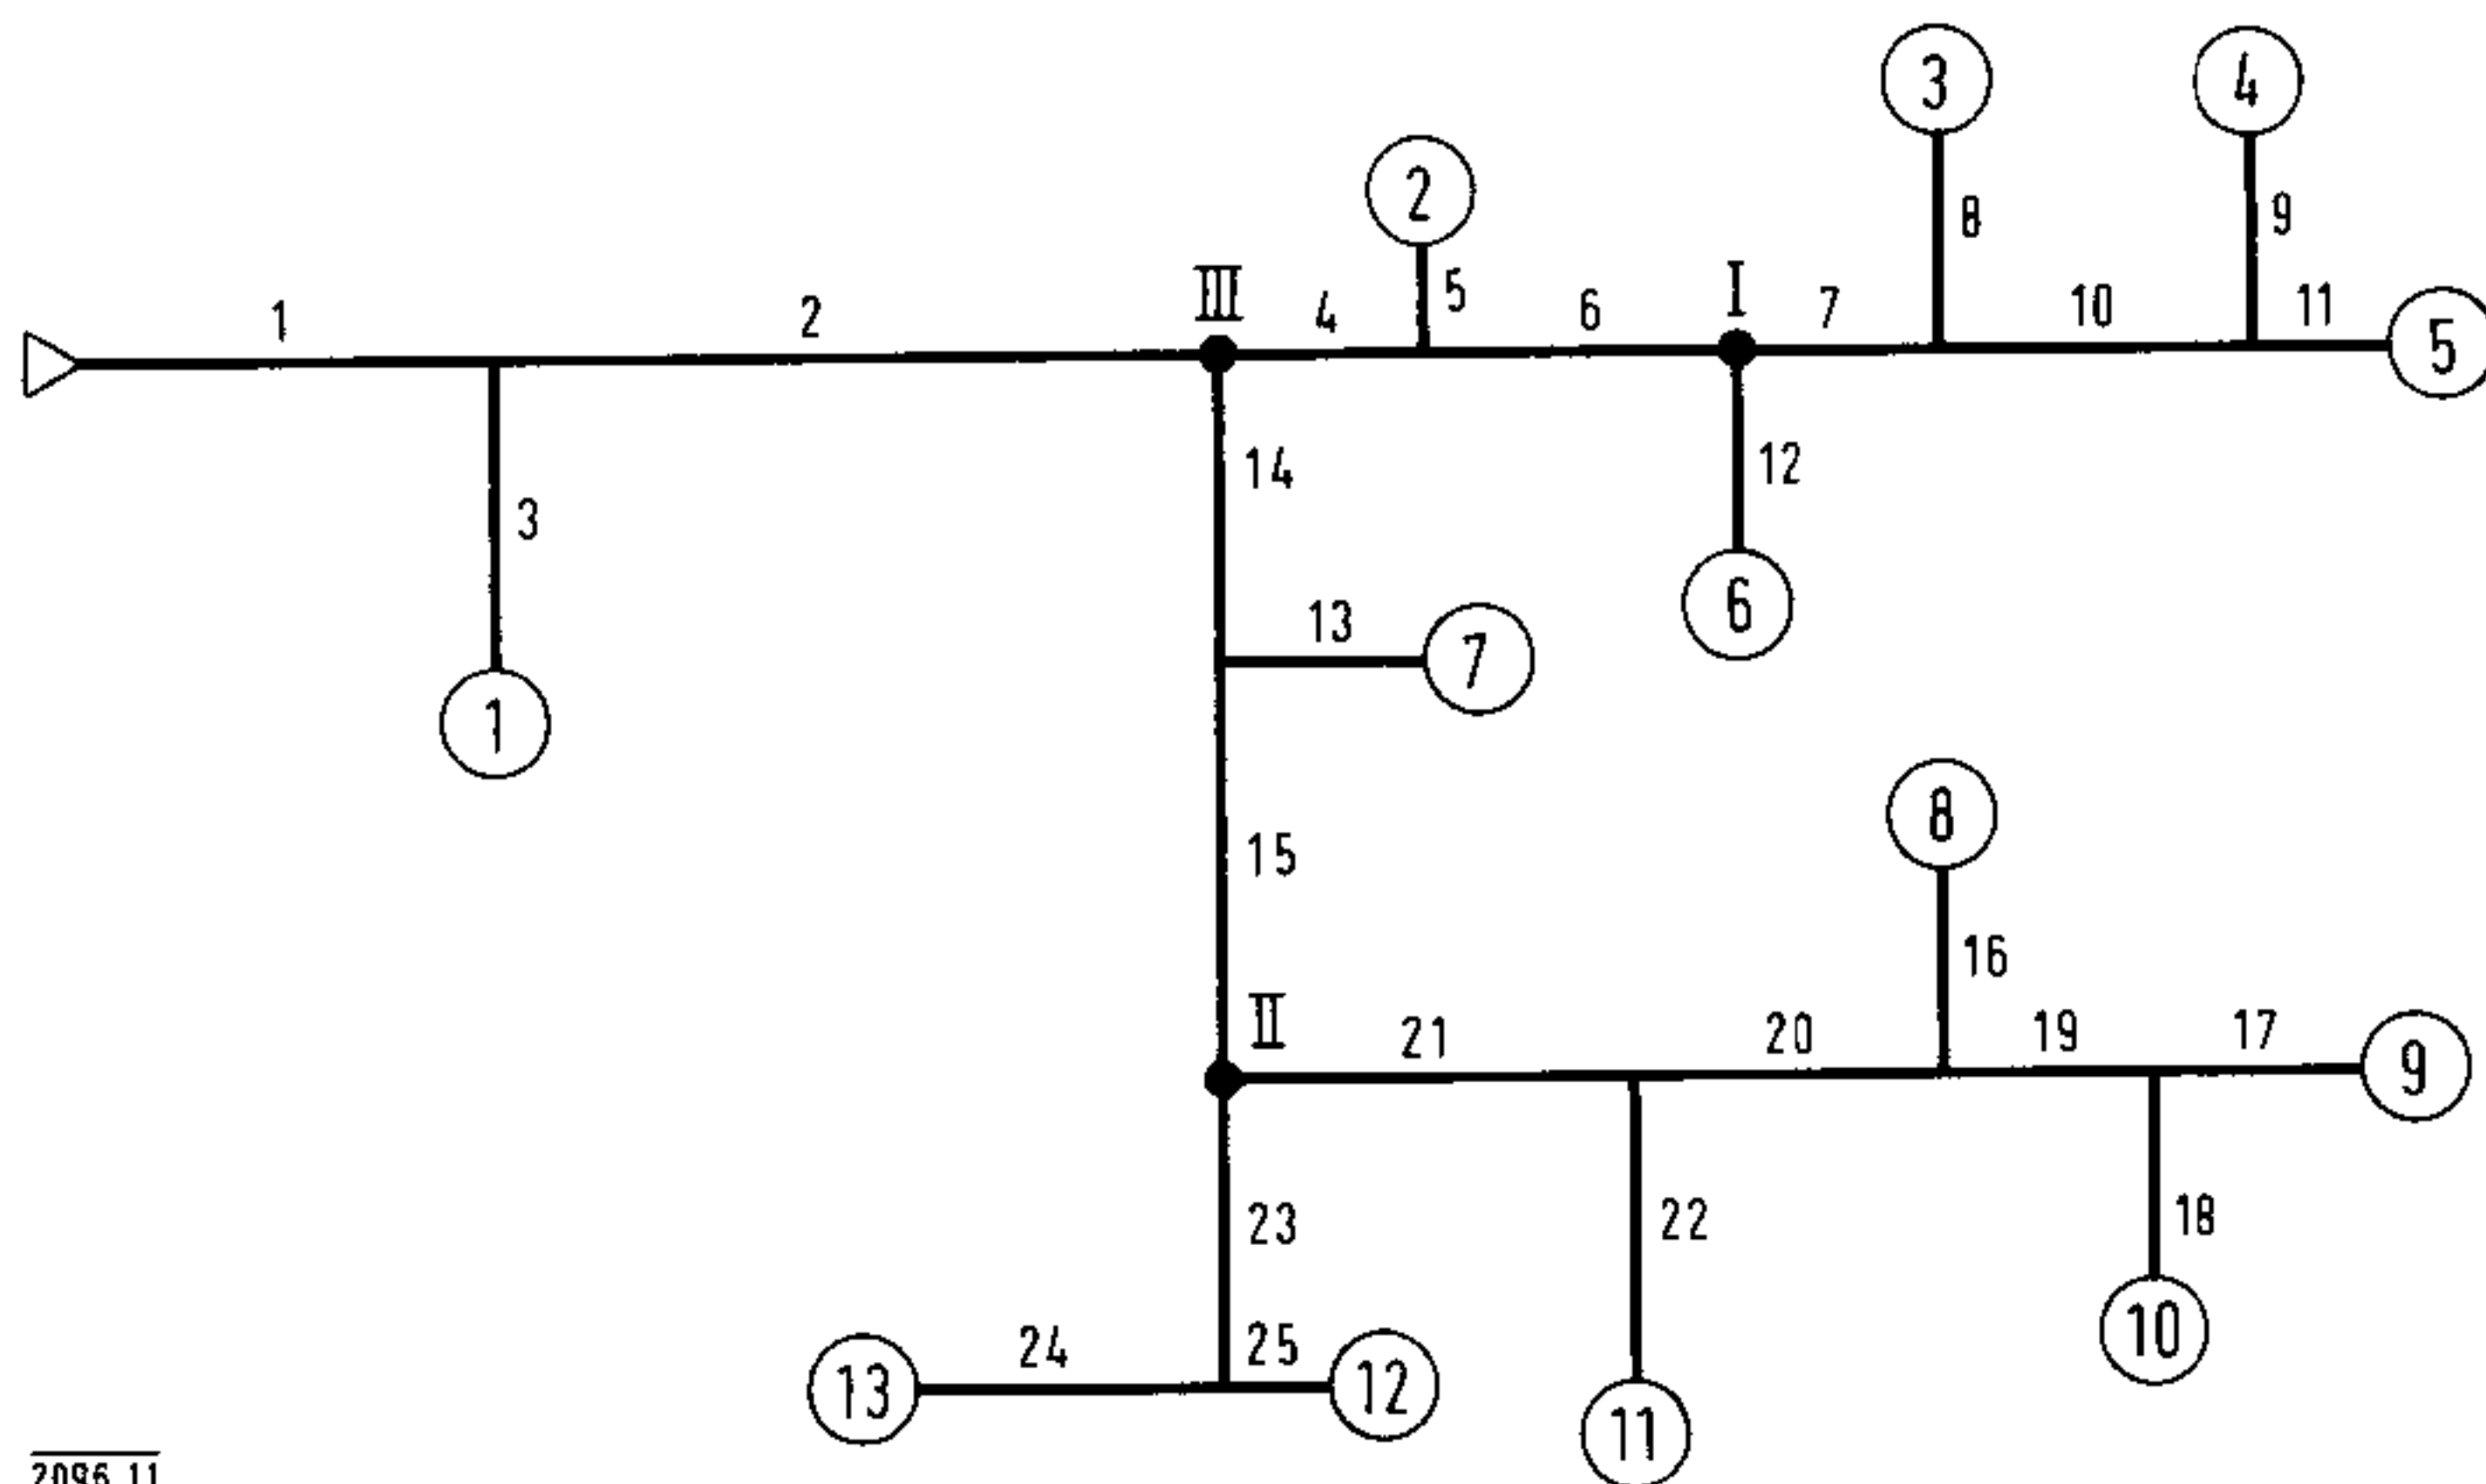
Wärmenetz mit drei möglichen Überströmeinrichtungen als Grundlage für Beispiel 3
